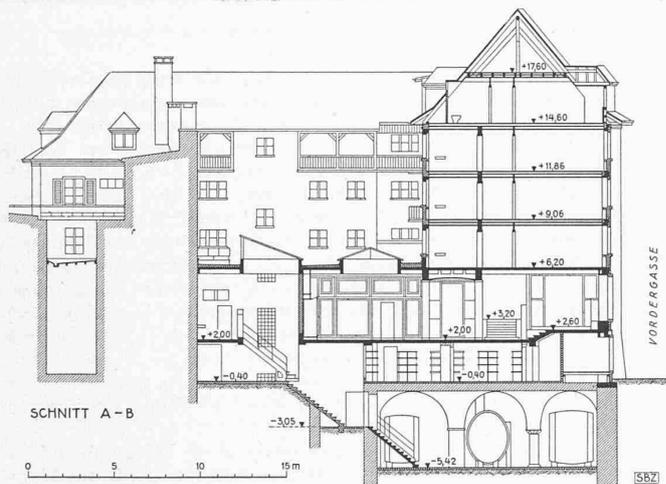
u. 12. Schnitte A-B u. C-D (vgl. Erdgeschoss-Grundriss)
